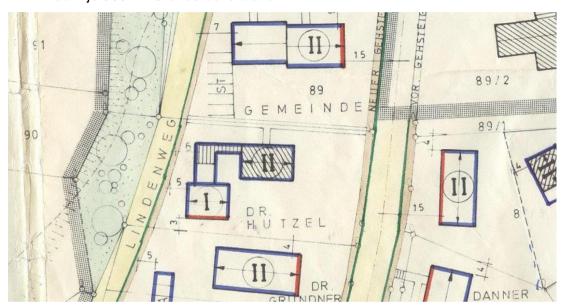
Planzeichnung Bebauungsplan "Häuselfeld", genehmigt am 27.03.1969, ohne Maßstab
